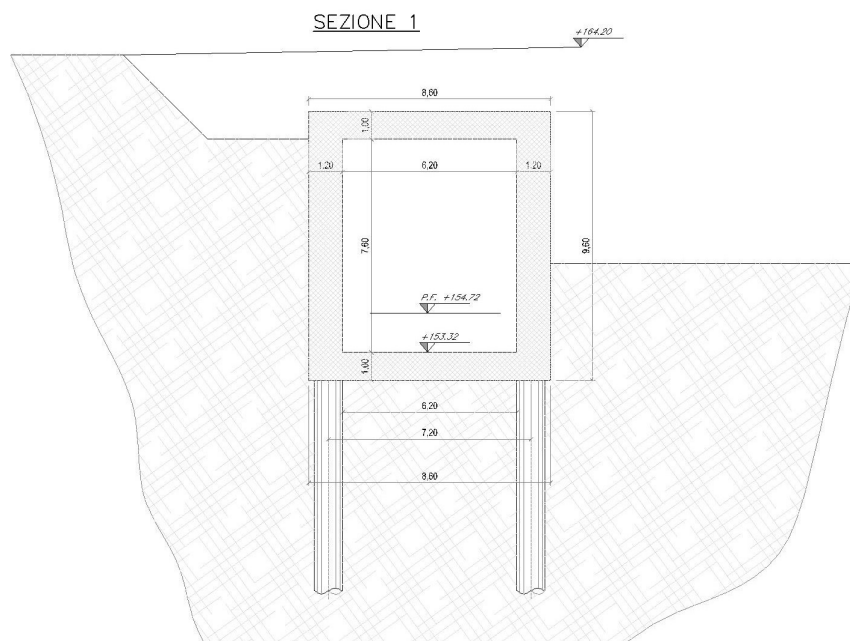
Sezione del manufatto oggetto della presente relazione di calcolo.
